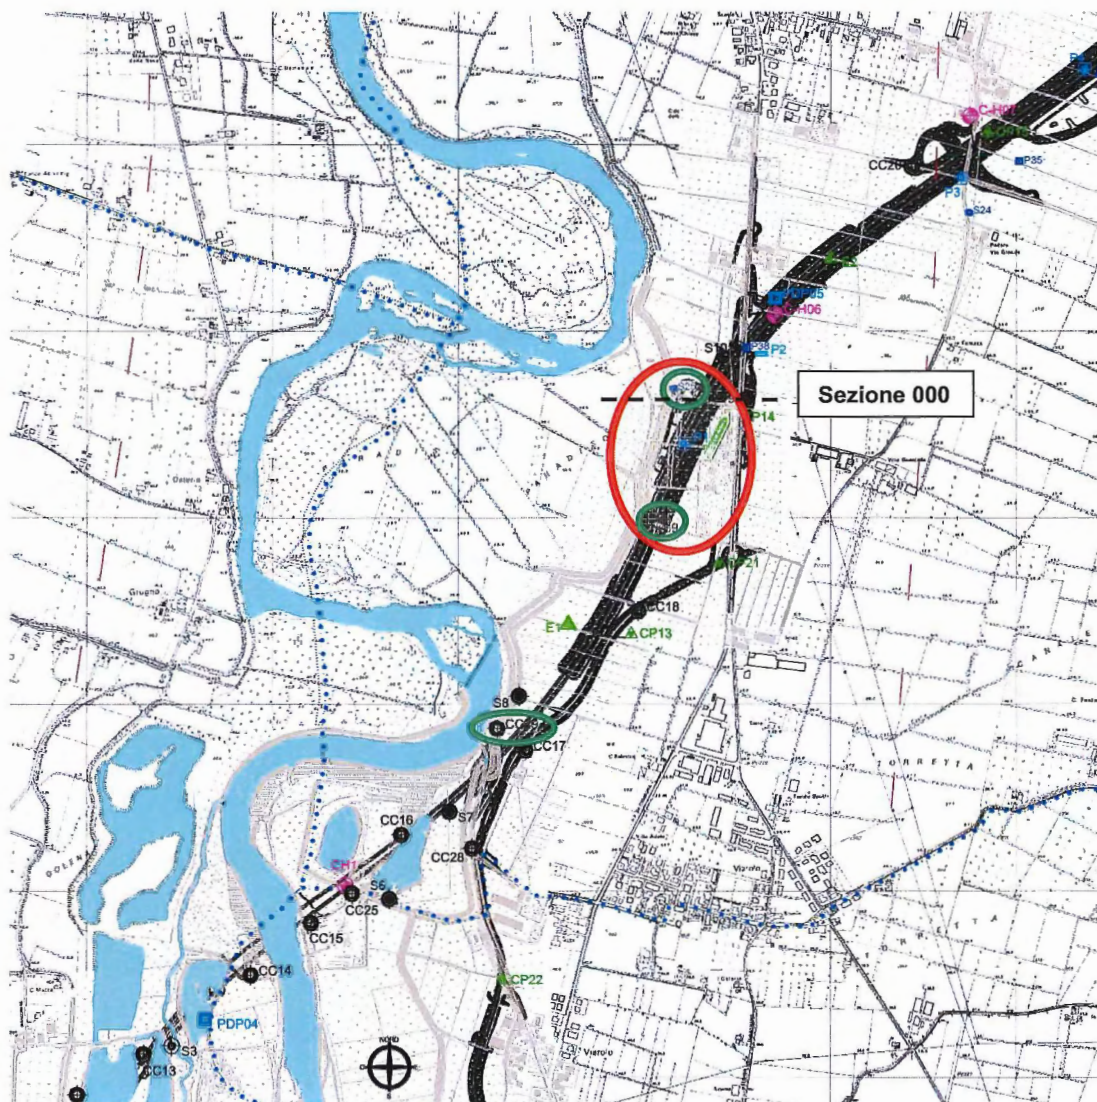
Estratto planimetria di progetto con ubicazione indagini
